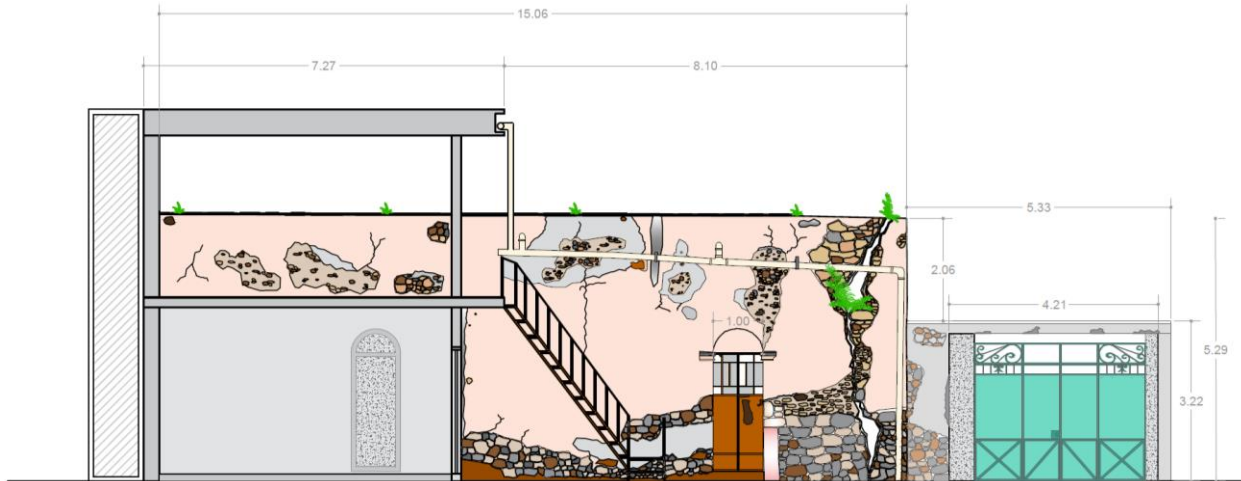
Fachada suroriente, sin escala. Elaboración propia
